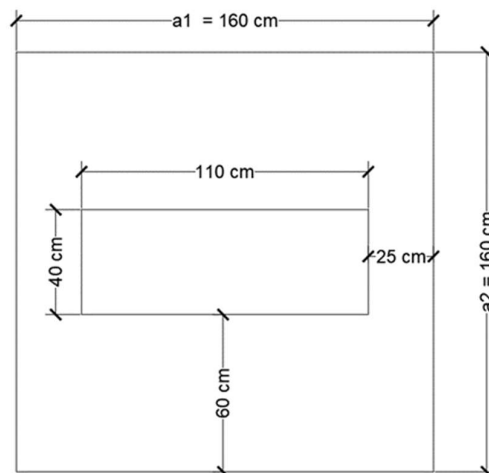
| Medidas adoptadas para la zapata. Fuente: Elaboración propia.
